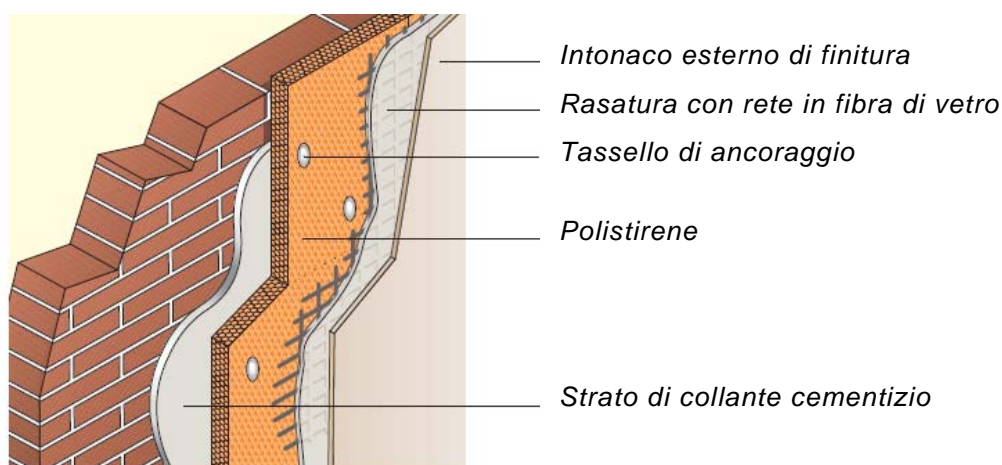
Esempio di stratigrafia di parete perimetrale esterna
